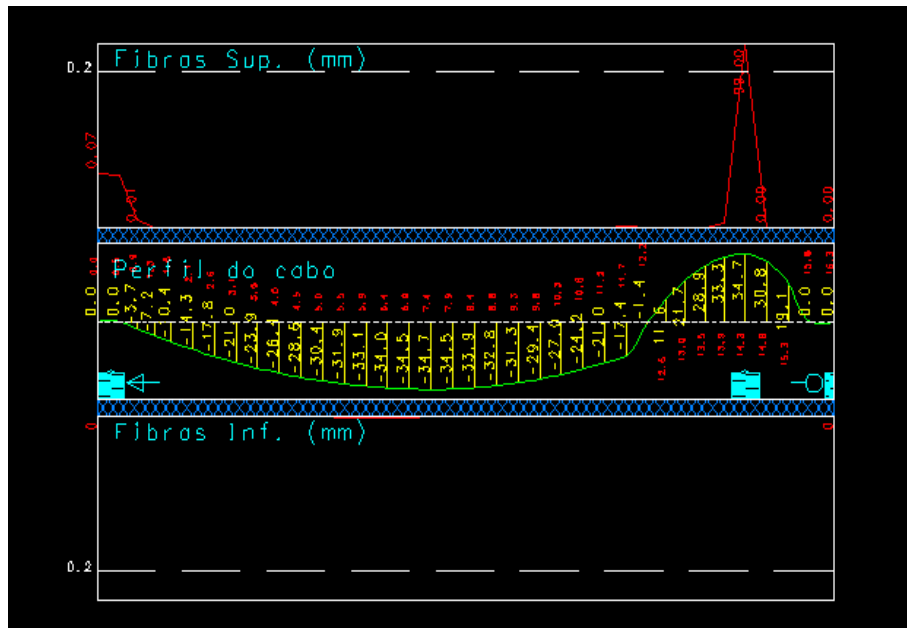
Fissuração viga V7 do subsolo (CAD/TQS)
